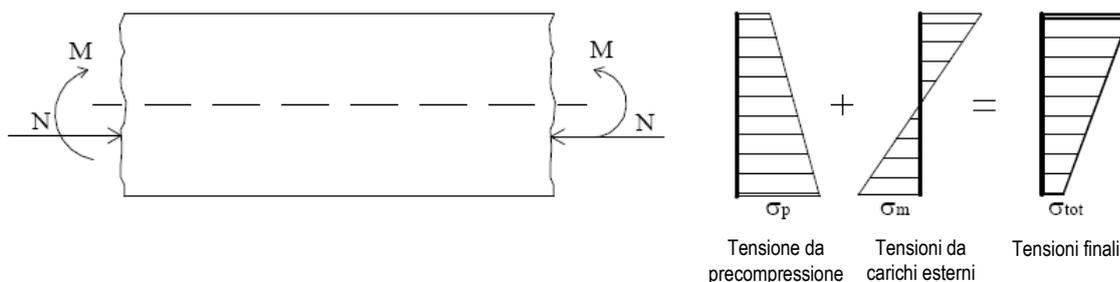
Effetto di sovrapposizione delle tensioni in una trave in c.a.p.
